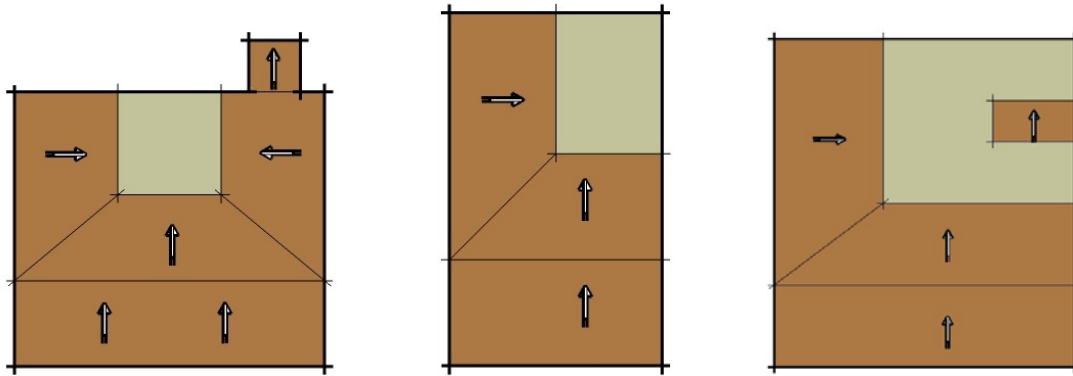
Plantas de cubiertas que se corresponden a los tipos anteriores
